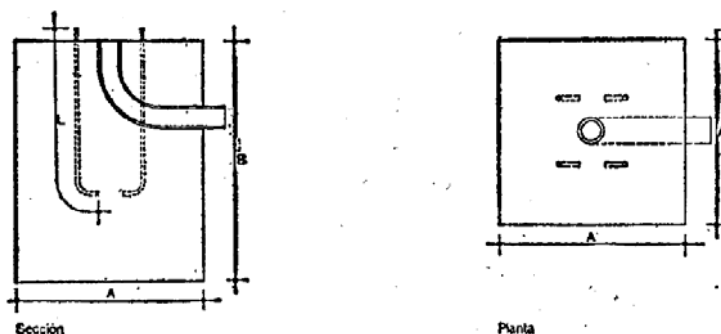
Plano de los dados de hormigón para la cimentación de báculos
